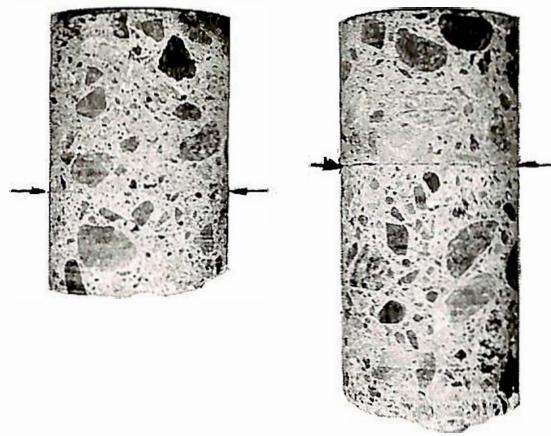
Borrkärnor, uttagna ur betongbeläggning som försetts med nytt slitlager av betong. Den horisontella fogen markerad med pilar.
